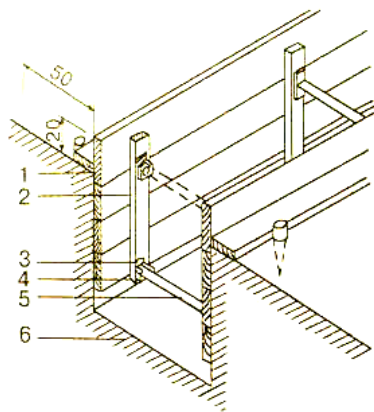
Схема улаштування розпірного укріплення стін траншеї:
